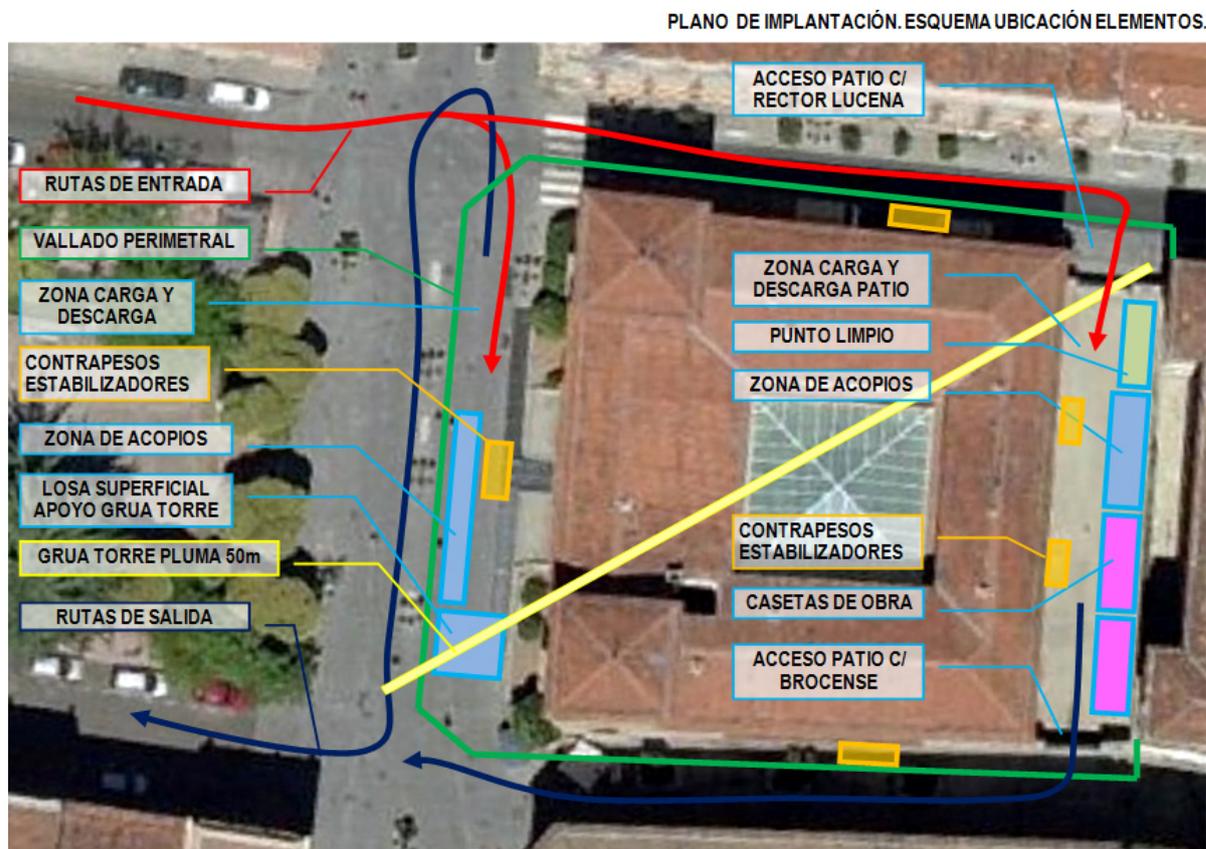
Plano de organización en planta. Fuente: Elaboración propia.
